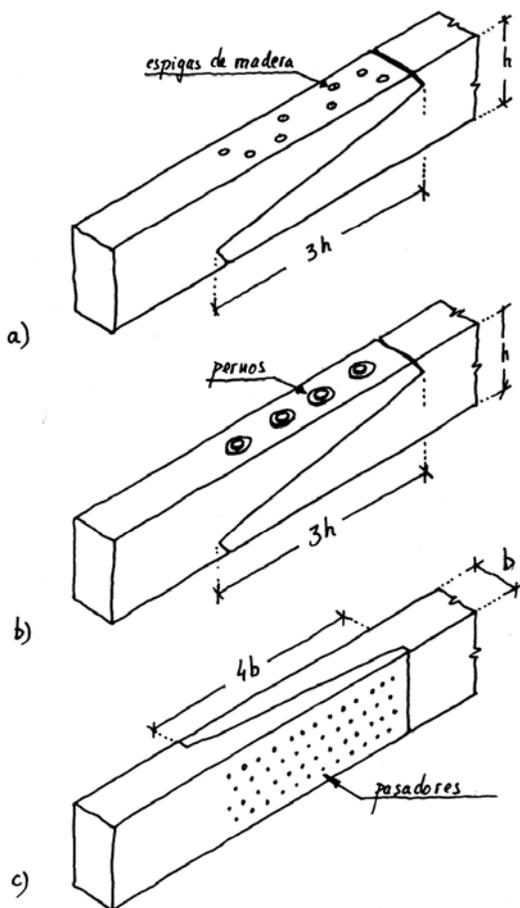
Consolidación de vigas con madera (Mettem et al., 1993).
